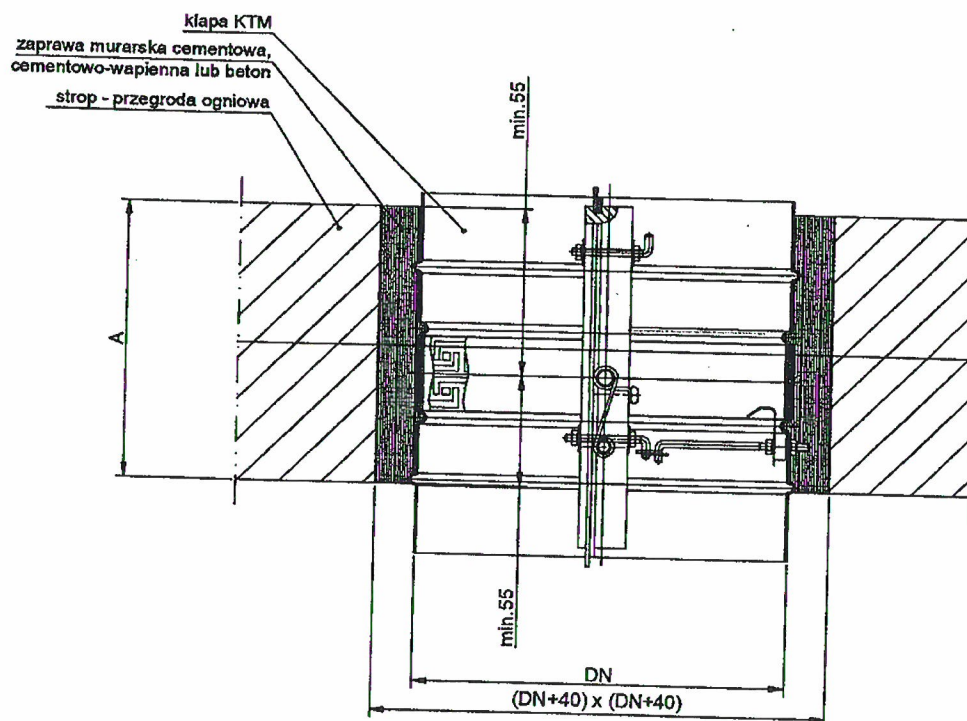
Montaż klapy KTM-mufa w ścianach betonowych i murowanych
